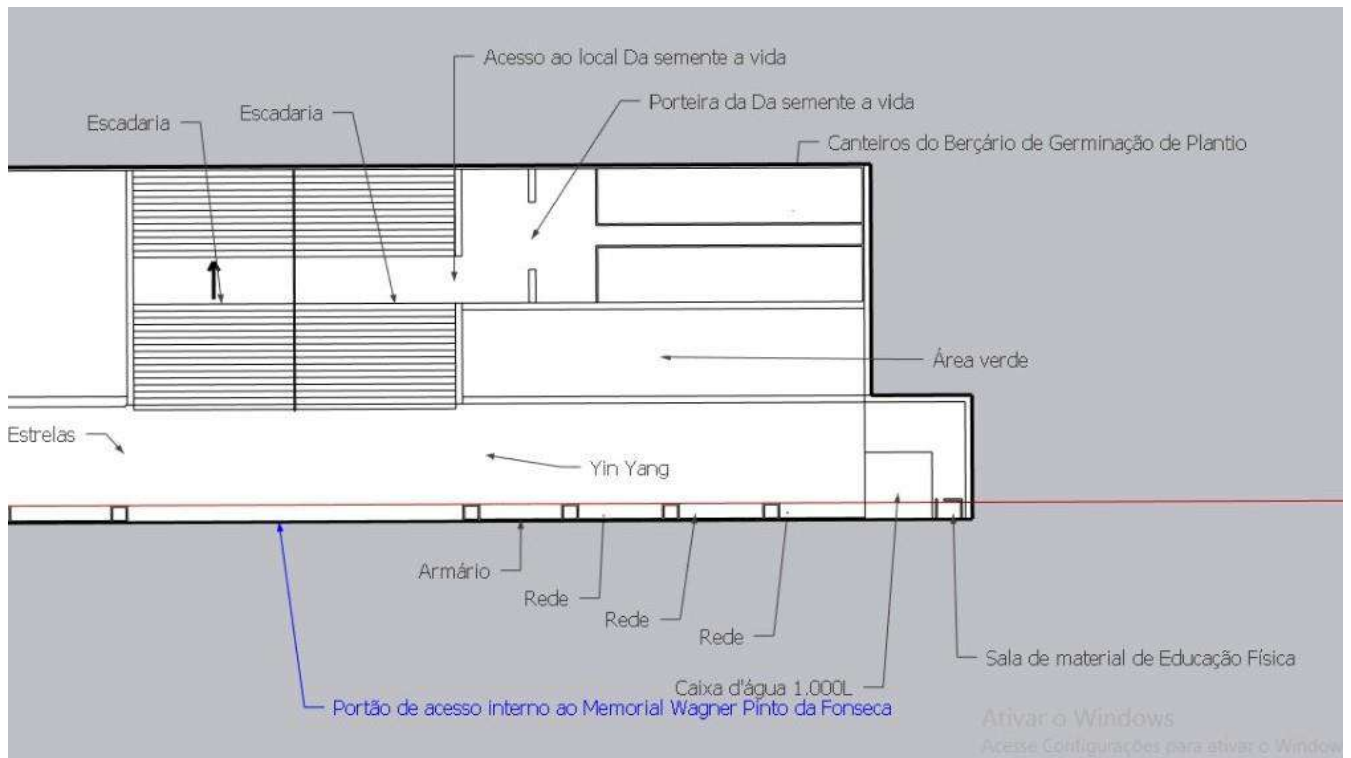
Planta baixa dos espaços Yin Yang e Da semente a Vida.
